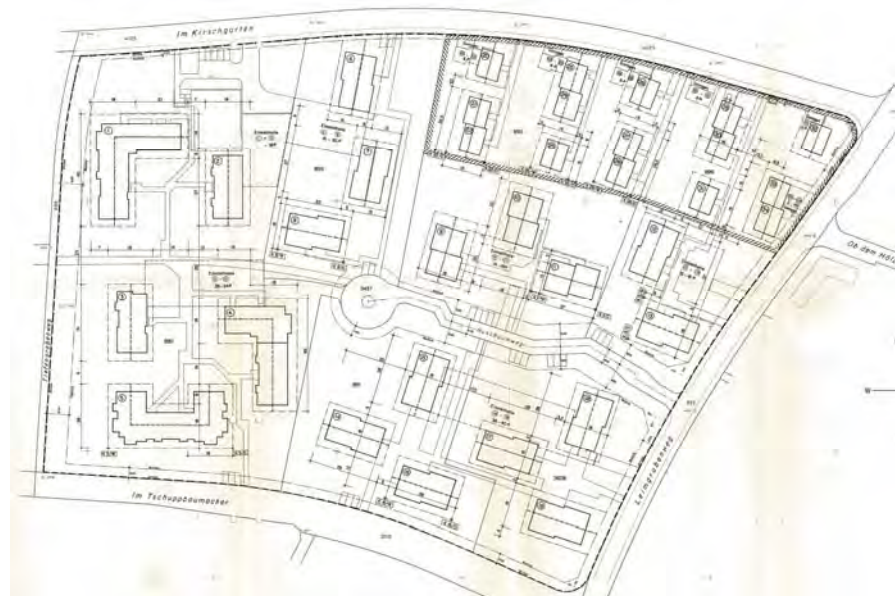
Rechtsgültiger Quartierplan „Kirschbaumacker“, Situationsplan
